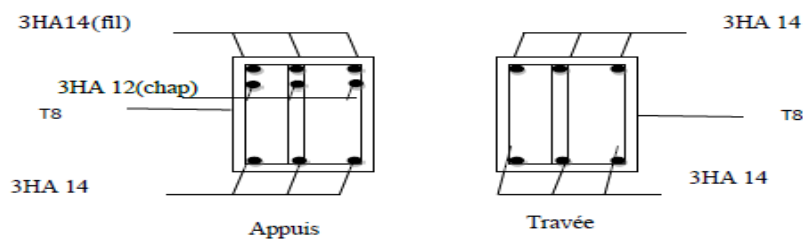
Schéma de ferrailage des poutres principales et des poutres secondaires
